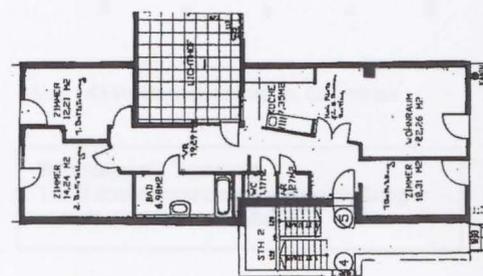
Peterstalstrasse, Block 3, Grundriss
